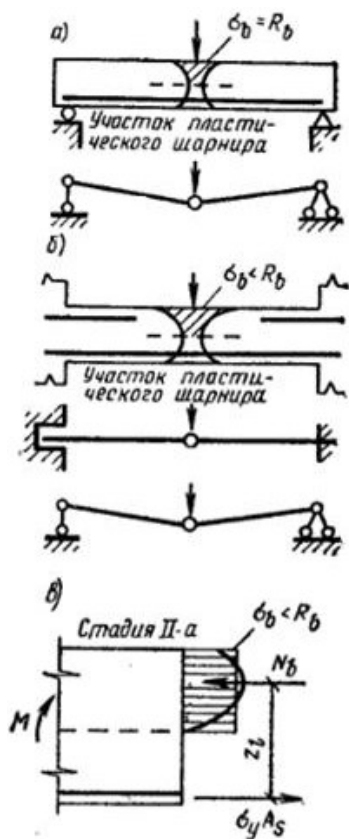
Схема образования пластического шарнира в железобетонных конструкциях
